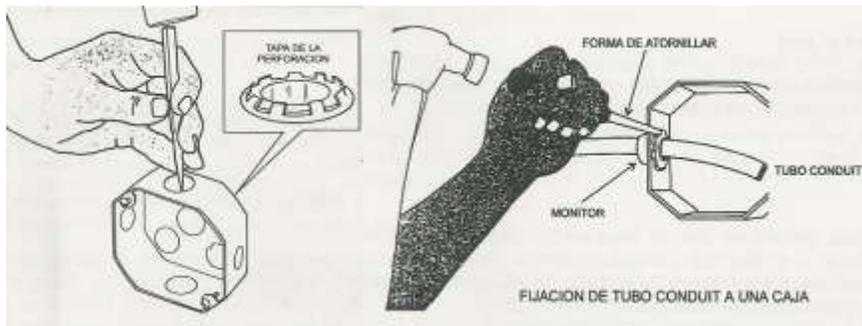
Perforación de una caja metálica y fijación de un tubo conduit a la caja metálica.
